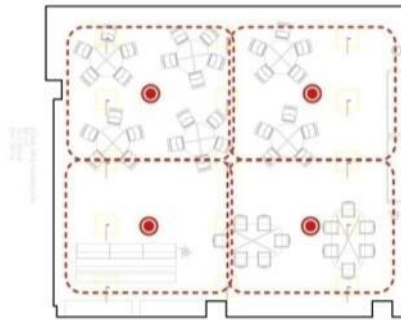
Distribución de Sensores. Área de Descanso y/o Restauración.
